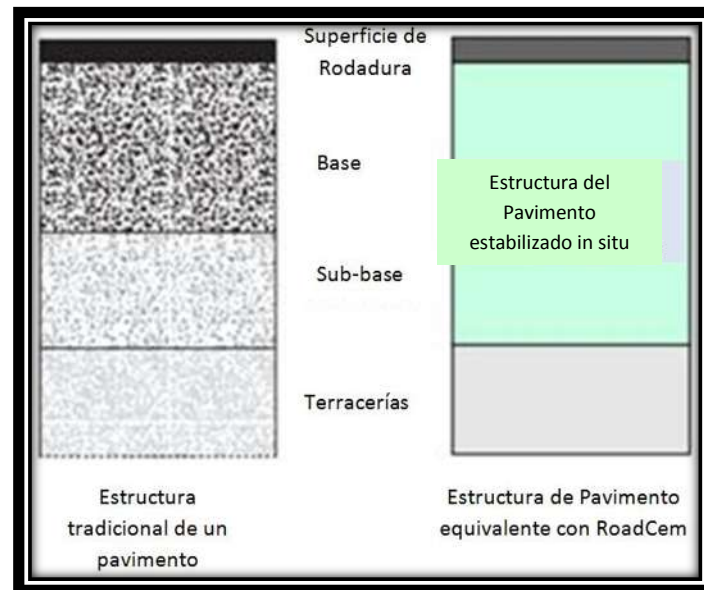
Comparativo de una Estructura de Pavimento Tradicional con una Estructura elaborada con RoadCem.
